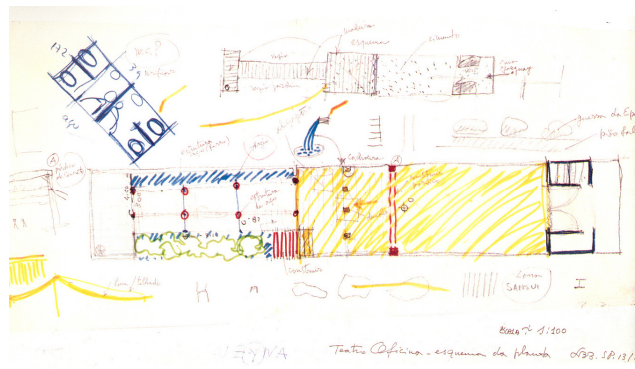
Estudo de planta para o Teatro Oficina.
